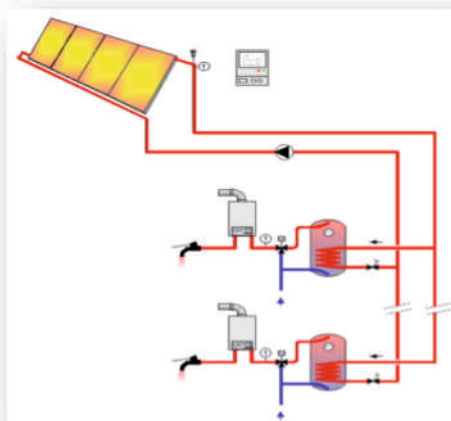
Installation solaire avec accumulation distribuée (CESCI) et appoint individuel avec chaudière instantanée
